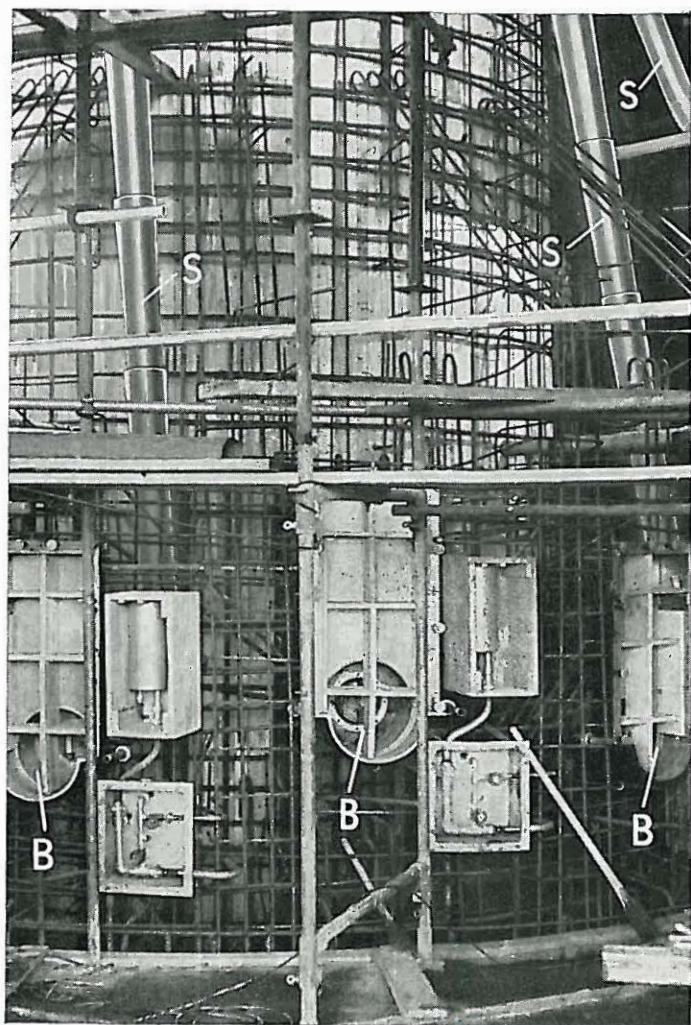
Bewehrung und Einbauten der Reaktorwand mit innerer Beckenschalung (gleiche Stelle wie Bild 2; S Schüttröhre für den Beton, B Bestrahlungsrohre)
